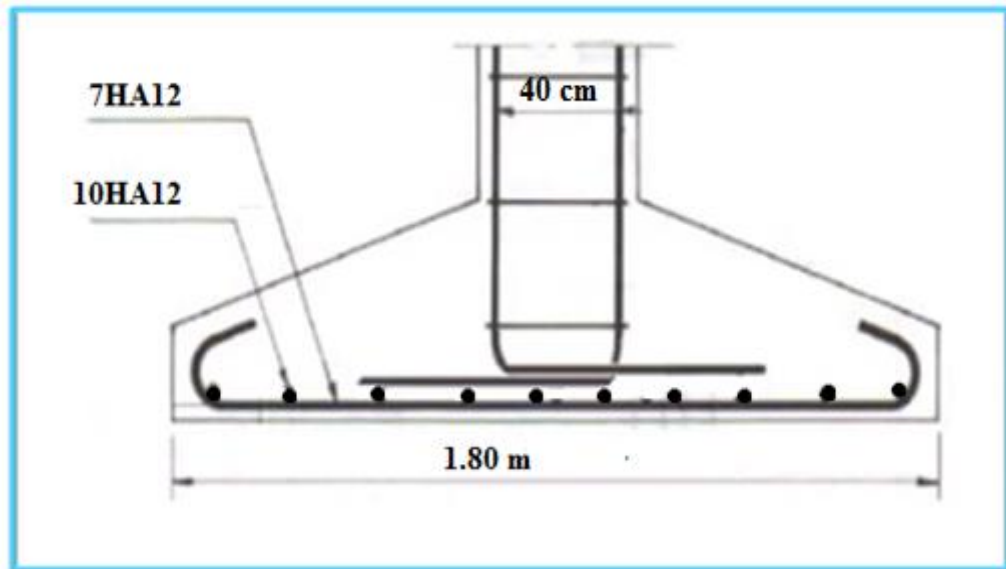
Ferrailage de la semelle isolée sous poteau (30*40) sans Y-Y.
